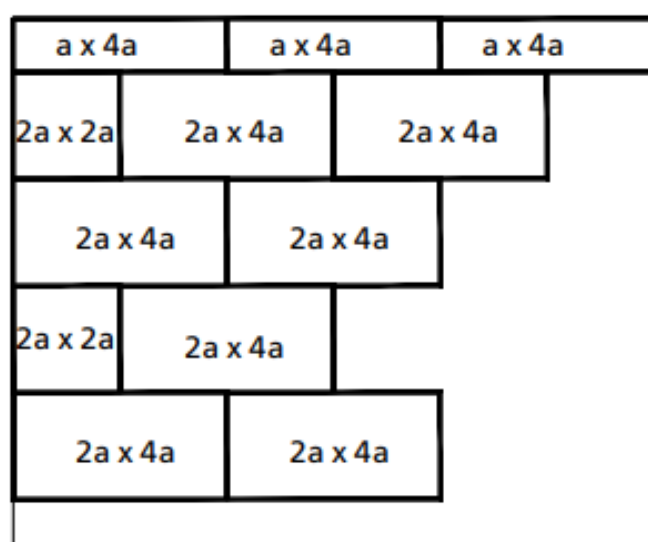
Схема укладки первого (нижнего) слоя теплоизоляции
